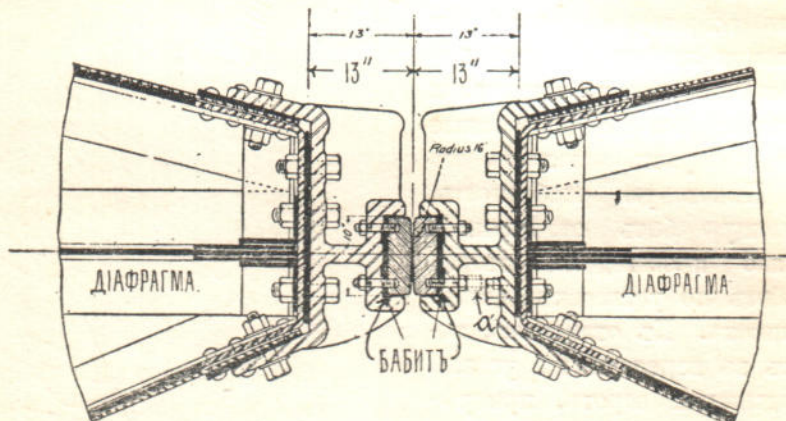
Составныя отливки въ мѣстѣ упора створныхъ столбовъ.
